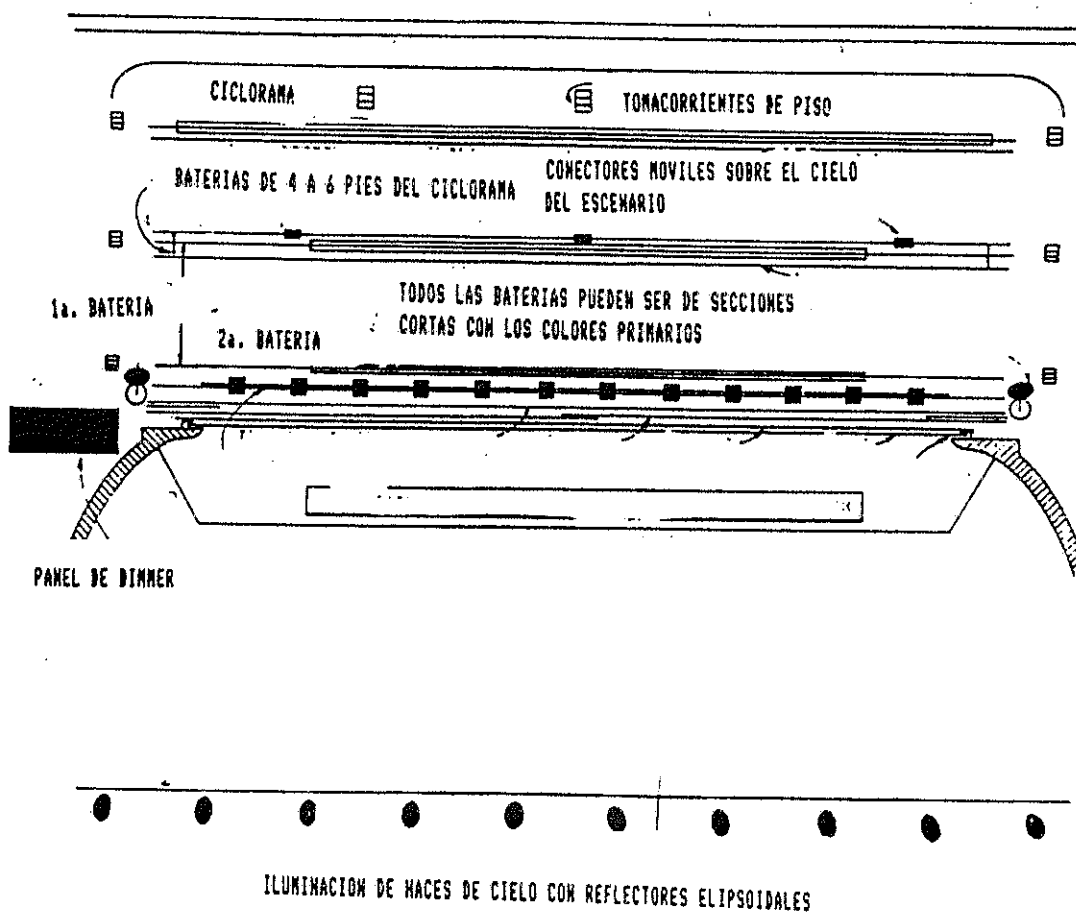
Plan general de iluminación de un escenario, en el cual se muestra la localización del equipo más común utilizado, vista de planta.
